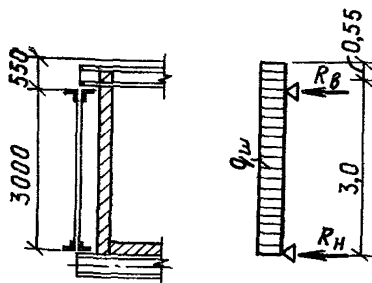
Схема ветровых нагрузок, действующих на поперечное сечение галерей
